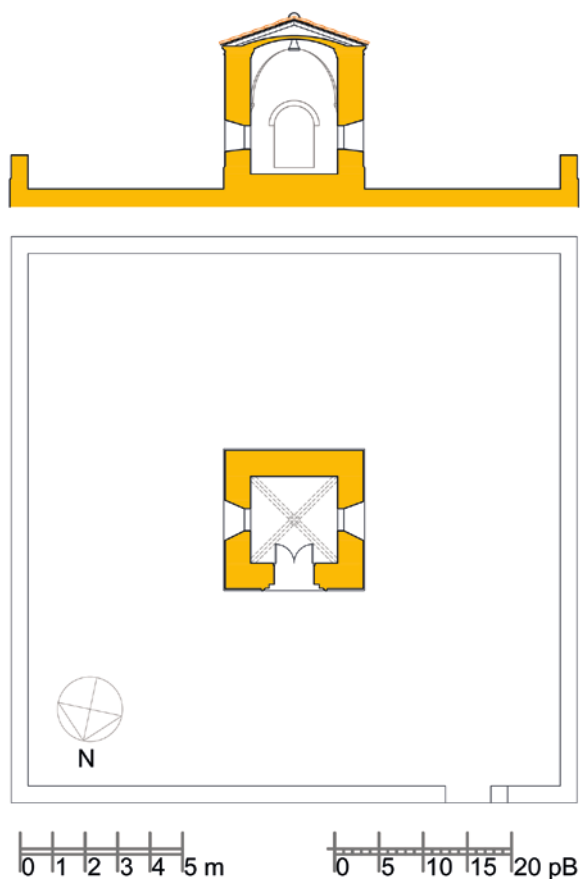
Brozas, la Capilla del Buen Jesús, planta general y sección
